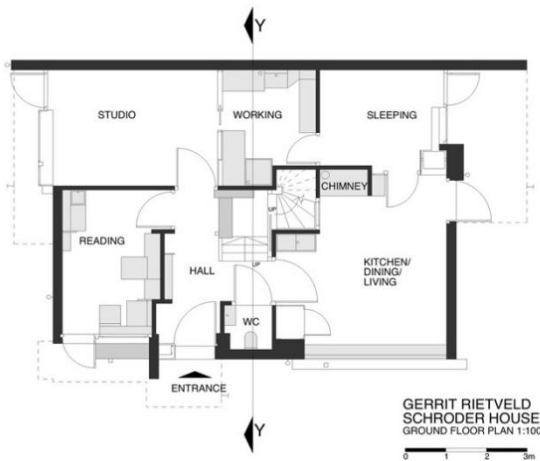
Casa Rietveld Schroder, planta do rés-do-chão
